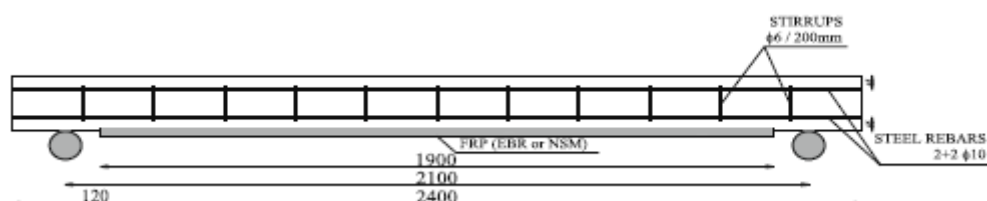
Vigas de betão armado reforçadas com CFRP ensaiadas à flexão por Bilotta *et al.* (2015).
